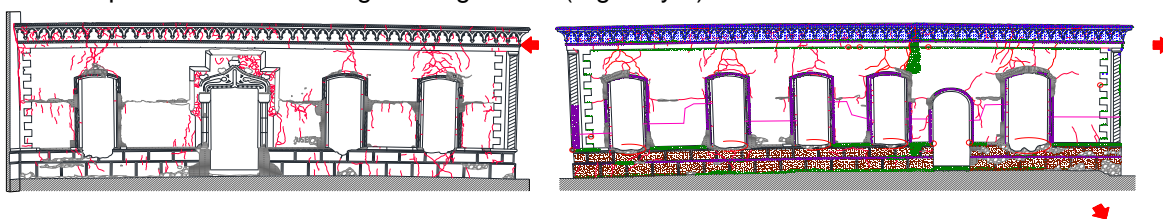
Alzados este y norte. Se aprecia la deformación convexa así como las fisuras y grietas en rojo.
